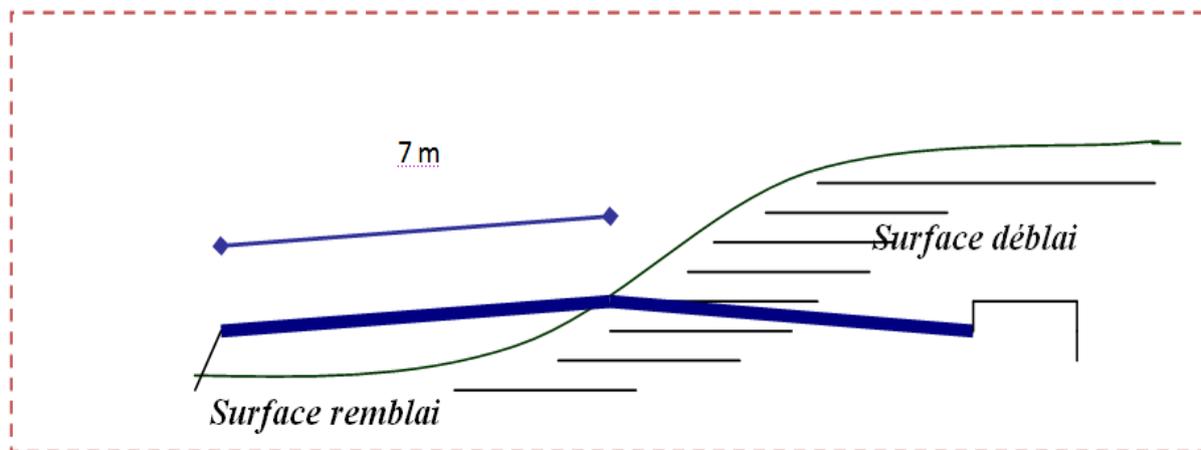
Les sections des profils en travers d'un tracé donné.
